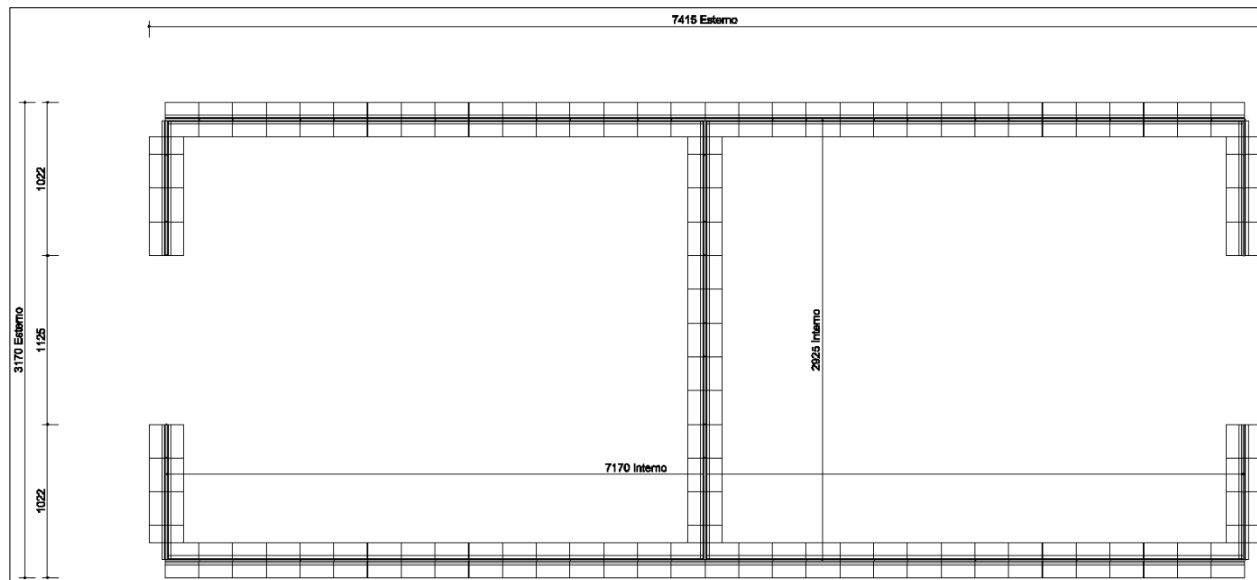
/A - Pianta del fabbricato in progetto (non in scala).
